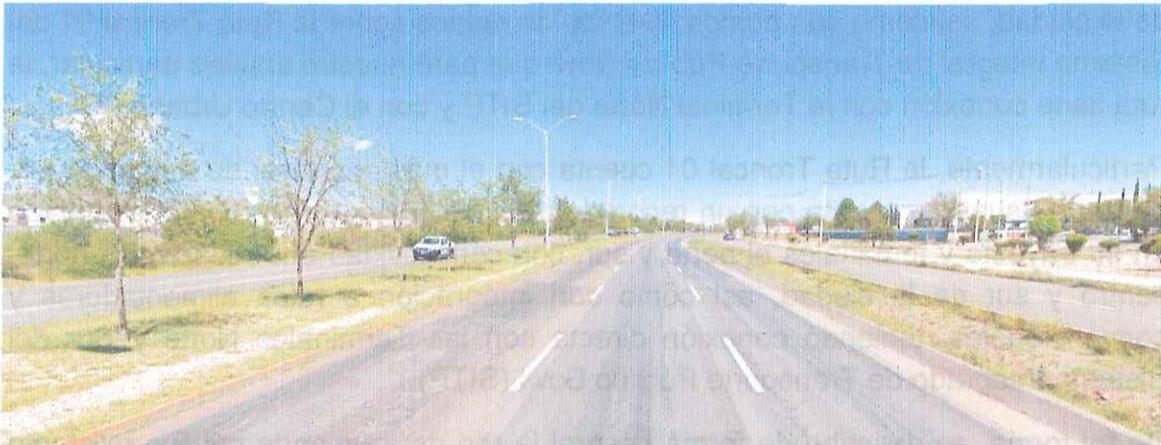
Sección Vial actual Av. Tecnológico. Fuente: Imagen Propia
